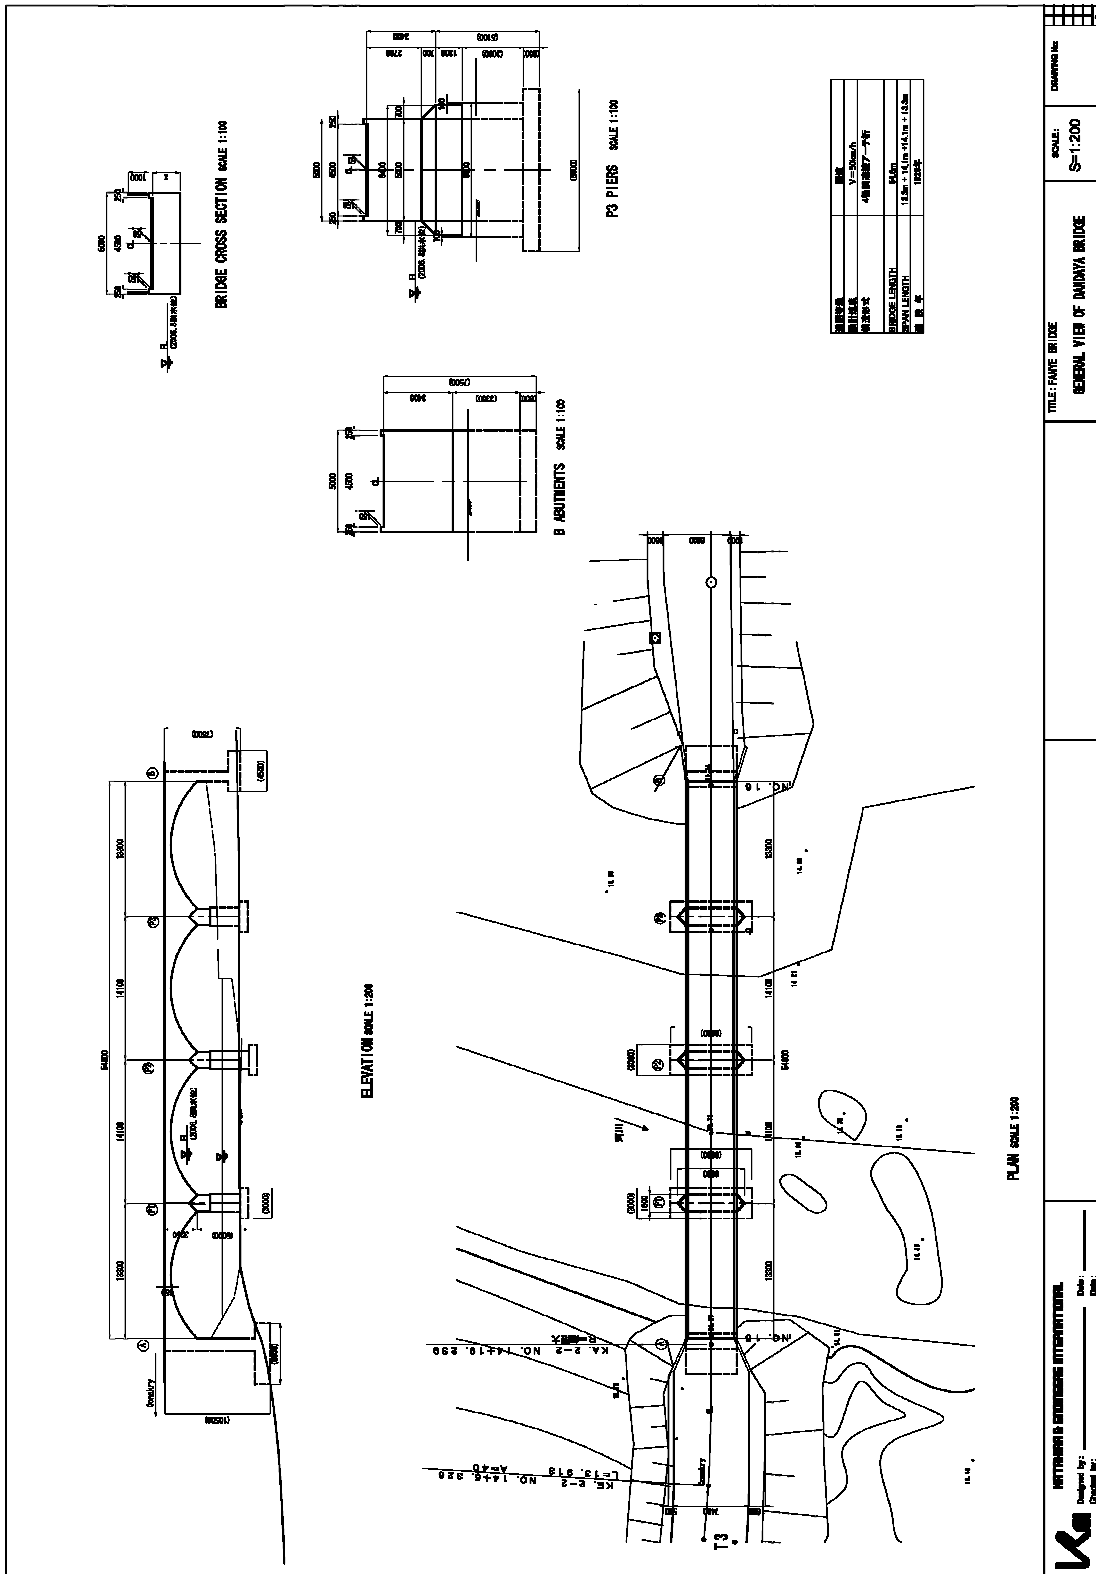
Plan général du pont actuel (Pont Dandaya)
